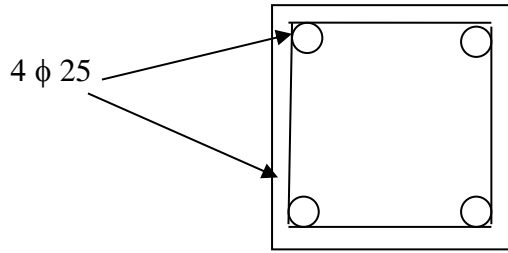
Ferrailage du poteau selon le code EUROCODE
